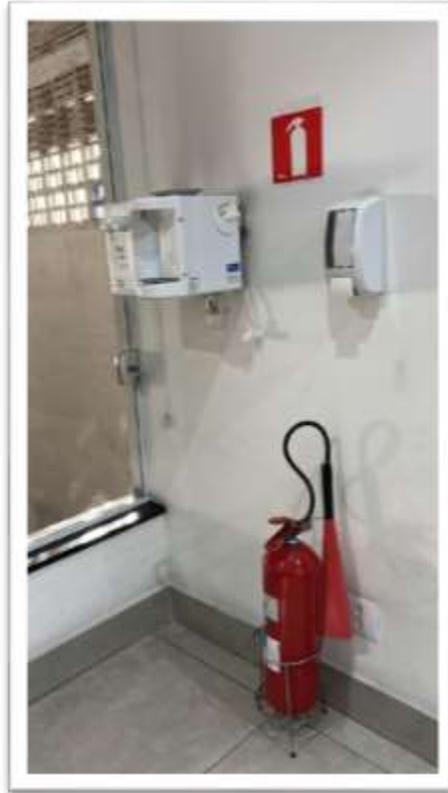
Equipamento de segurança contra incêndio –Arquivo Pessoal
